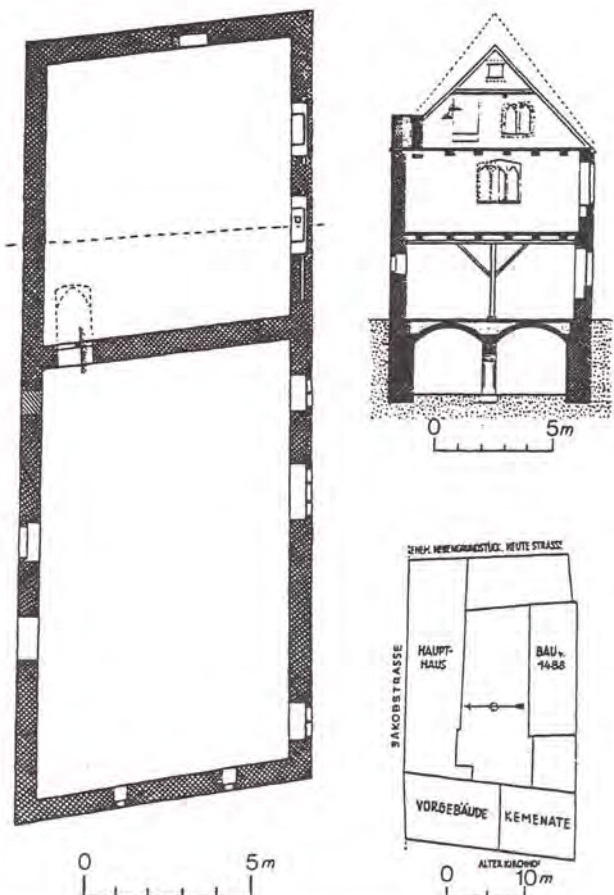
Braunschweig, Altstadt. Eiermarkt 2. Lageplan und Grundriß (Obergeschoß) des zerstörten Doppelhauses mit Querschnitt des Steinwerks (nach Fricke, aus RÖTTING ET AL. 1997)
